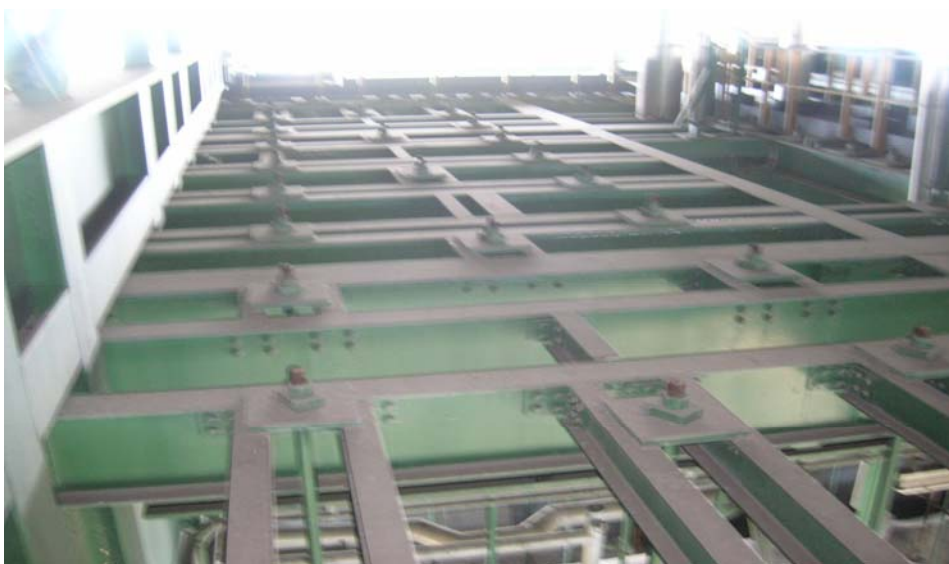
Area 1 Caldaia GR.8 - Particolare giunto struttura portante
